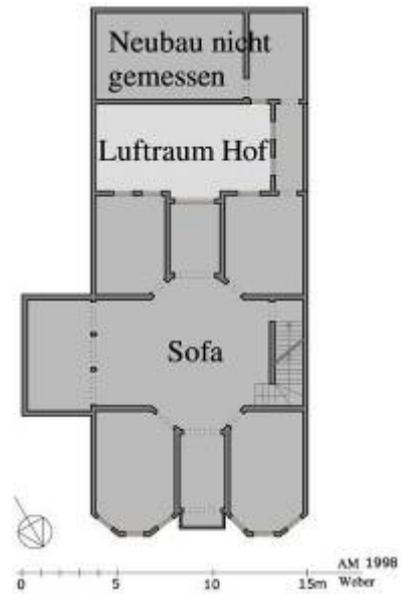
Bayt al-Kilāni [453], Grundriss OG
